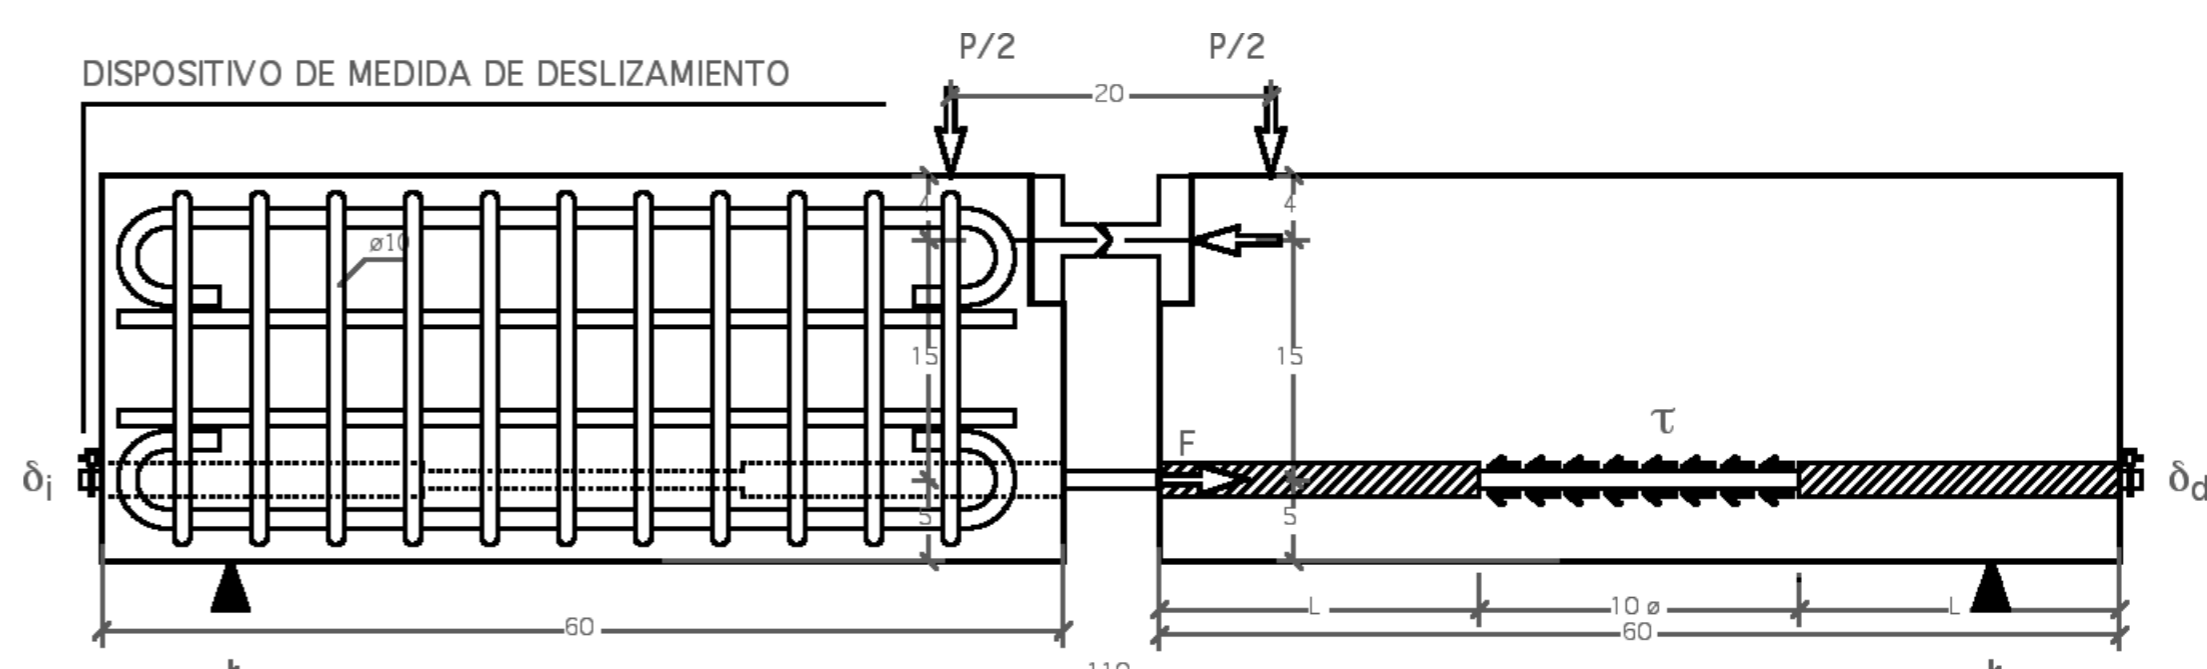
Dispositivo del ensayo beam test para Ø = 16 mm (UNE 36740.98).
